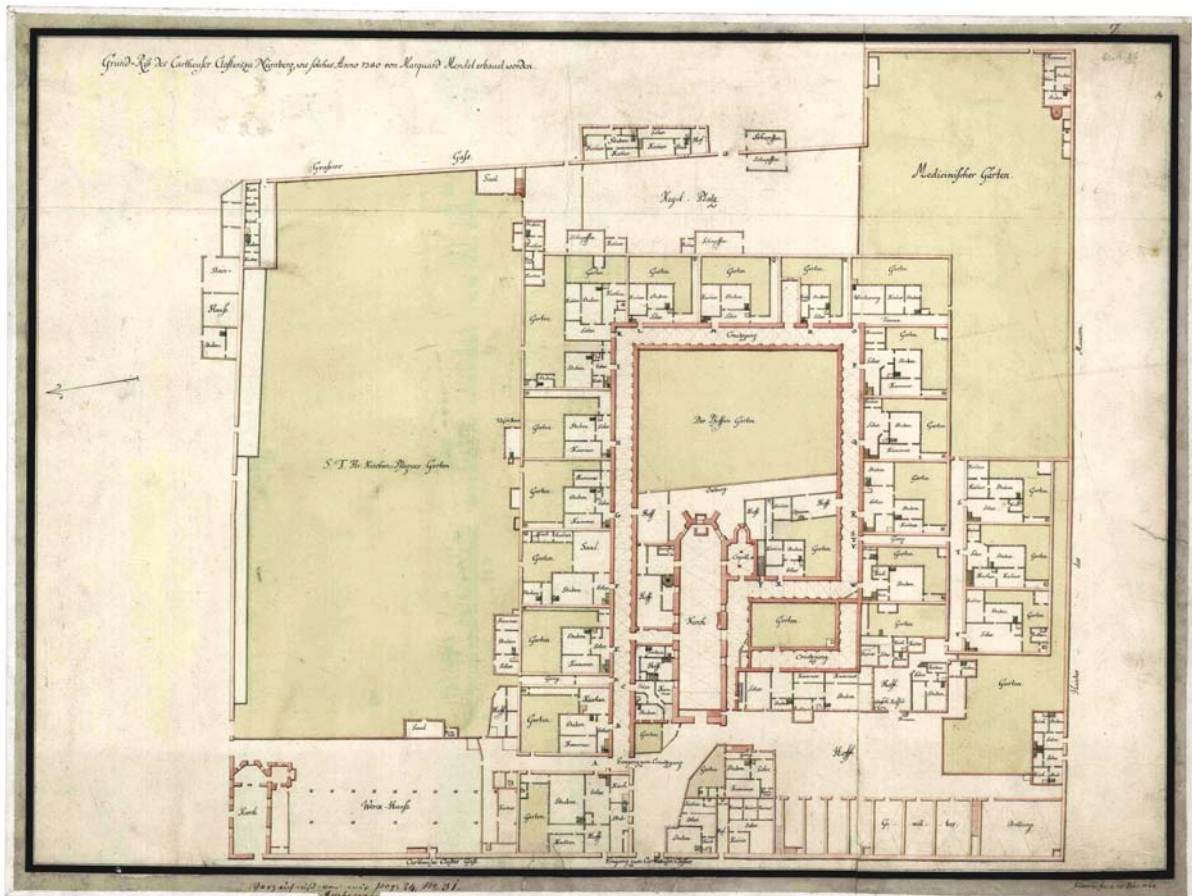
Silberrad – Grundriss der Kartause Nürnberg – 1760
